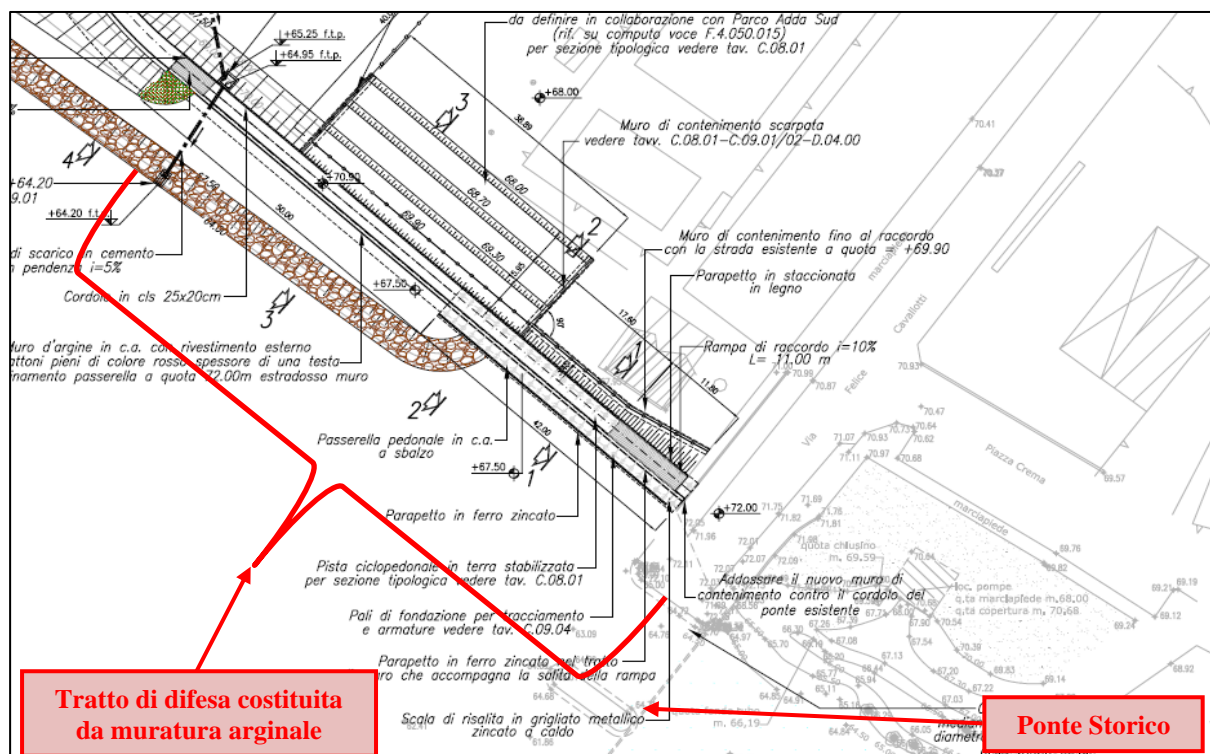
Planimetria di progetto muro arginale in sponda sinistra a monte del Ponte Storico
